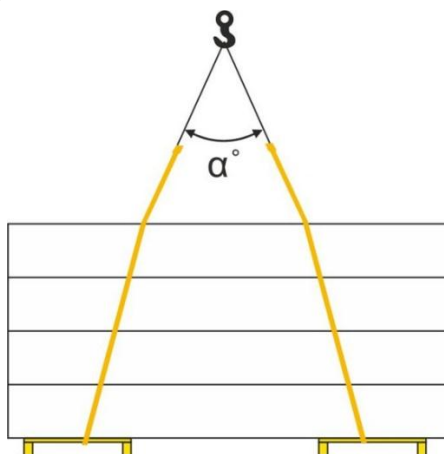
Разгрузка армированных изделий с использованием мягких строп
